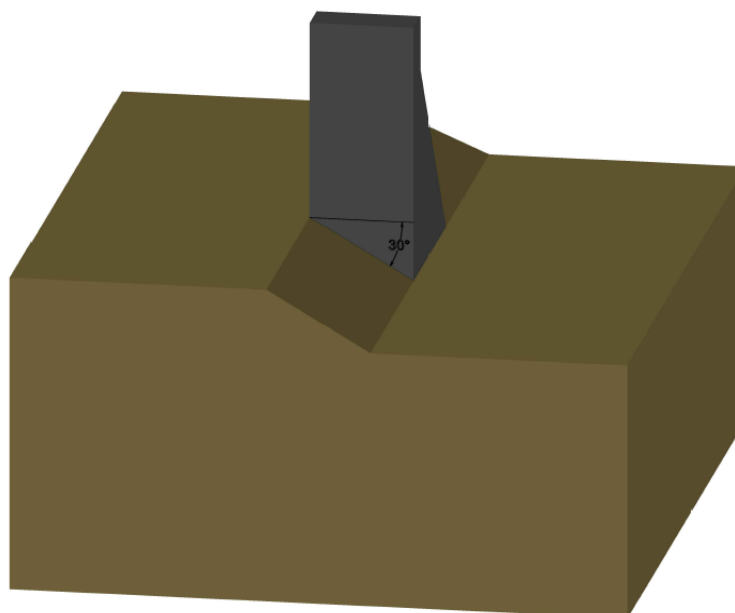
MODELO COM FUNDAÇÃO INCLINADA LIMITADO POR DOIS PLANOS HORIZONTAIS
